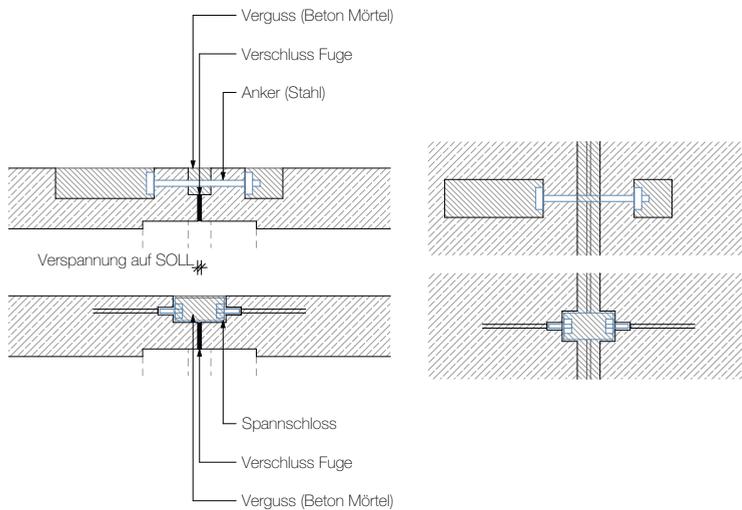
; Detail Modulverbindung horizontal, trocken, 1:20
